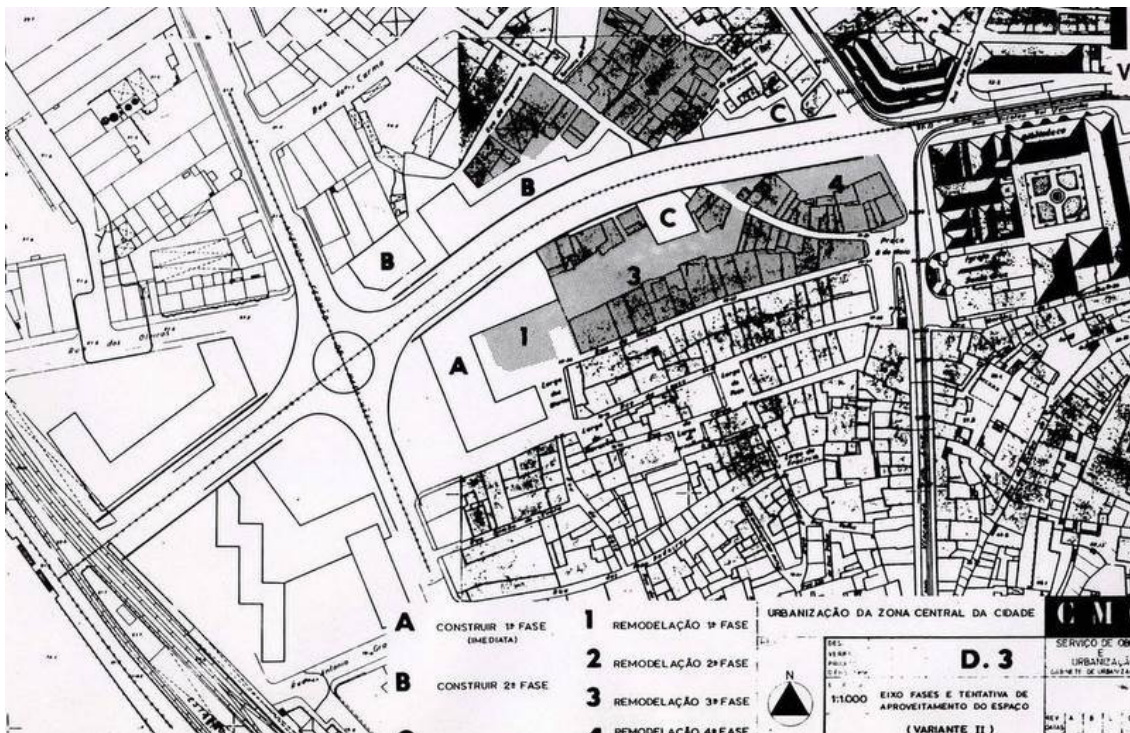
1970 – Zona a demolir na Baixa, por Januário Godinho;
